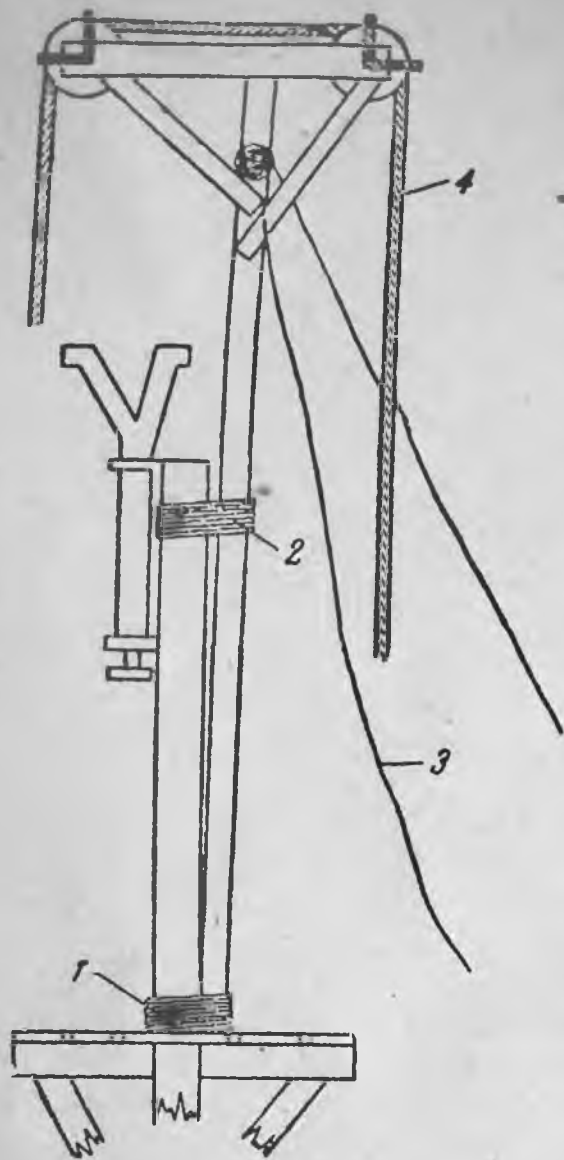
Вспомогательная стрела для монтажа и демонтажа узлов и деталей на рабочем мостике мачты: 1 — место нижнего крепления; 2 — место верхнего крепления; 3 — веревка-оттяжка; 4 — грузовой канат
